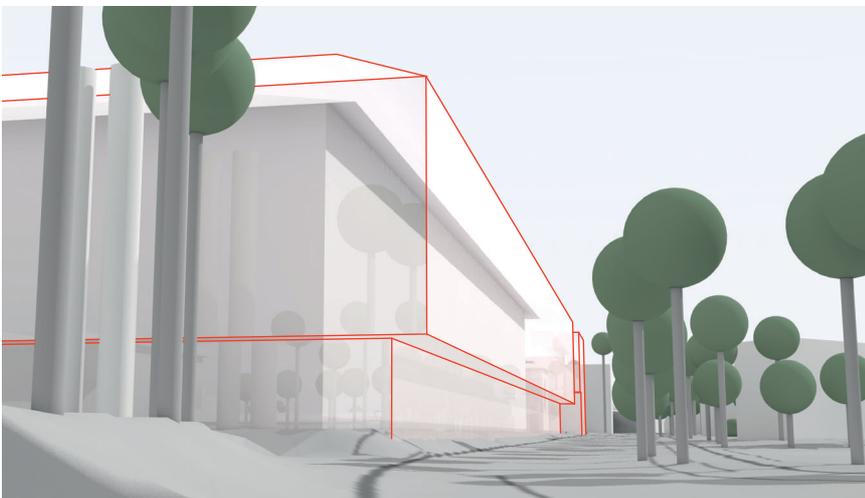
Digitales Modell der Baubereiche gemäss UeO, Sempachstrasse und Westfassade Stadion
